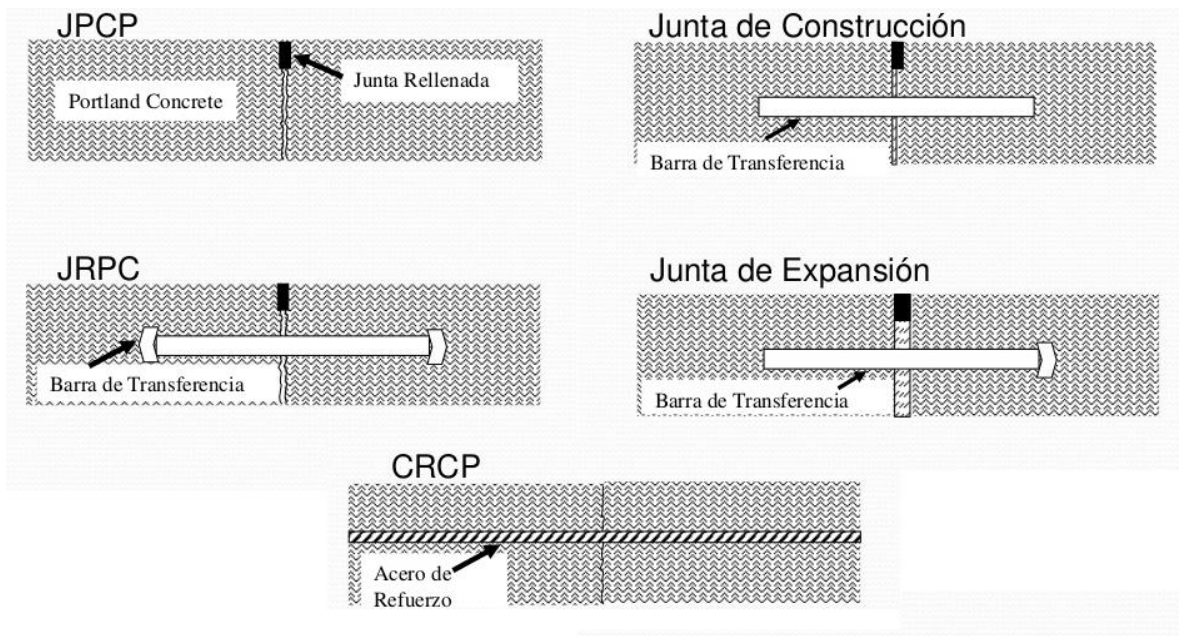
Fuente: Introducción a la Ingeniería de Pavimentos,
